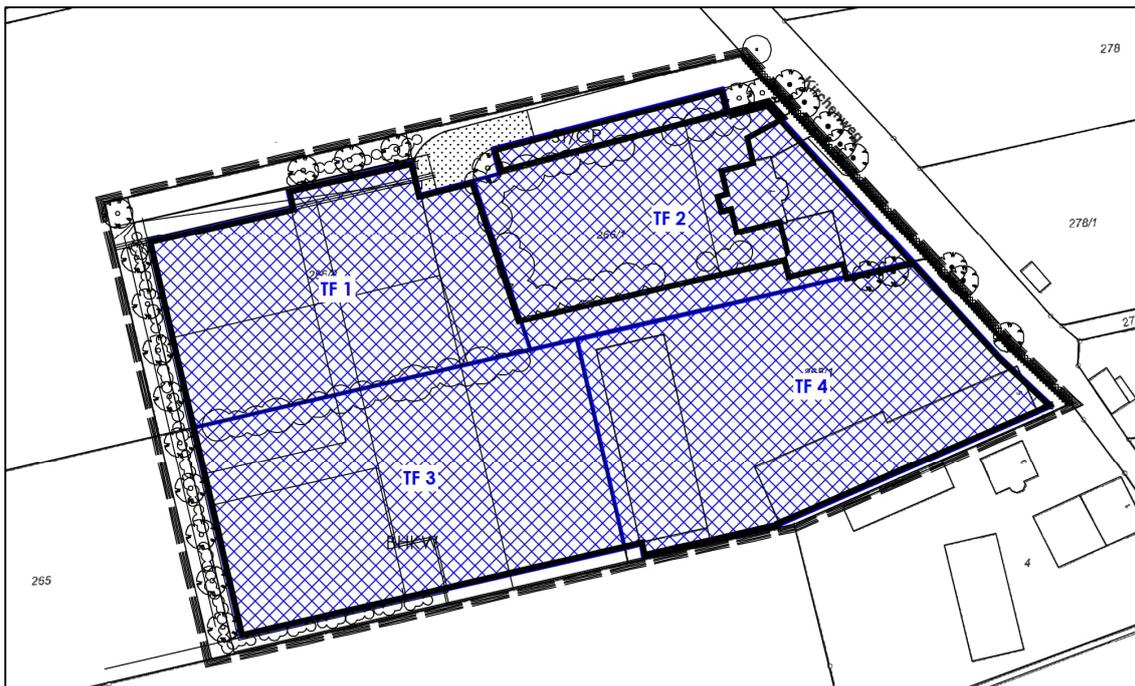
Lageplan mit Darstellung der Emissionsbezugsflächen S_{EK}
